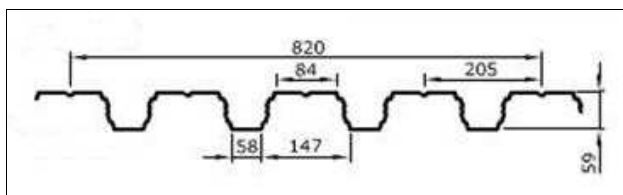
Geometría de la chapa perfilada trapezoidal de acero galvanizado.
